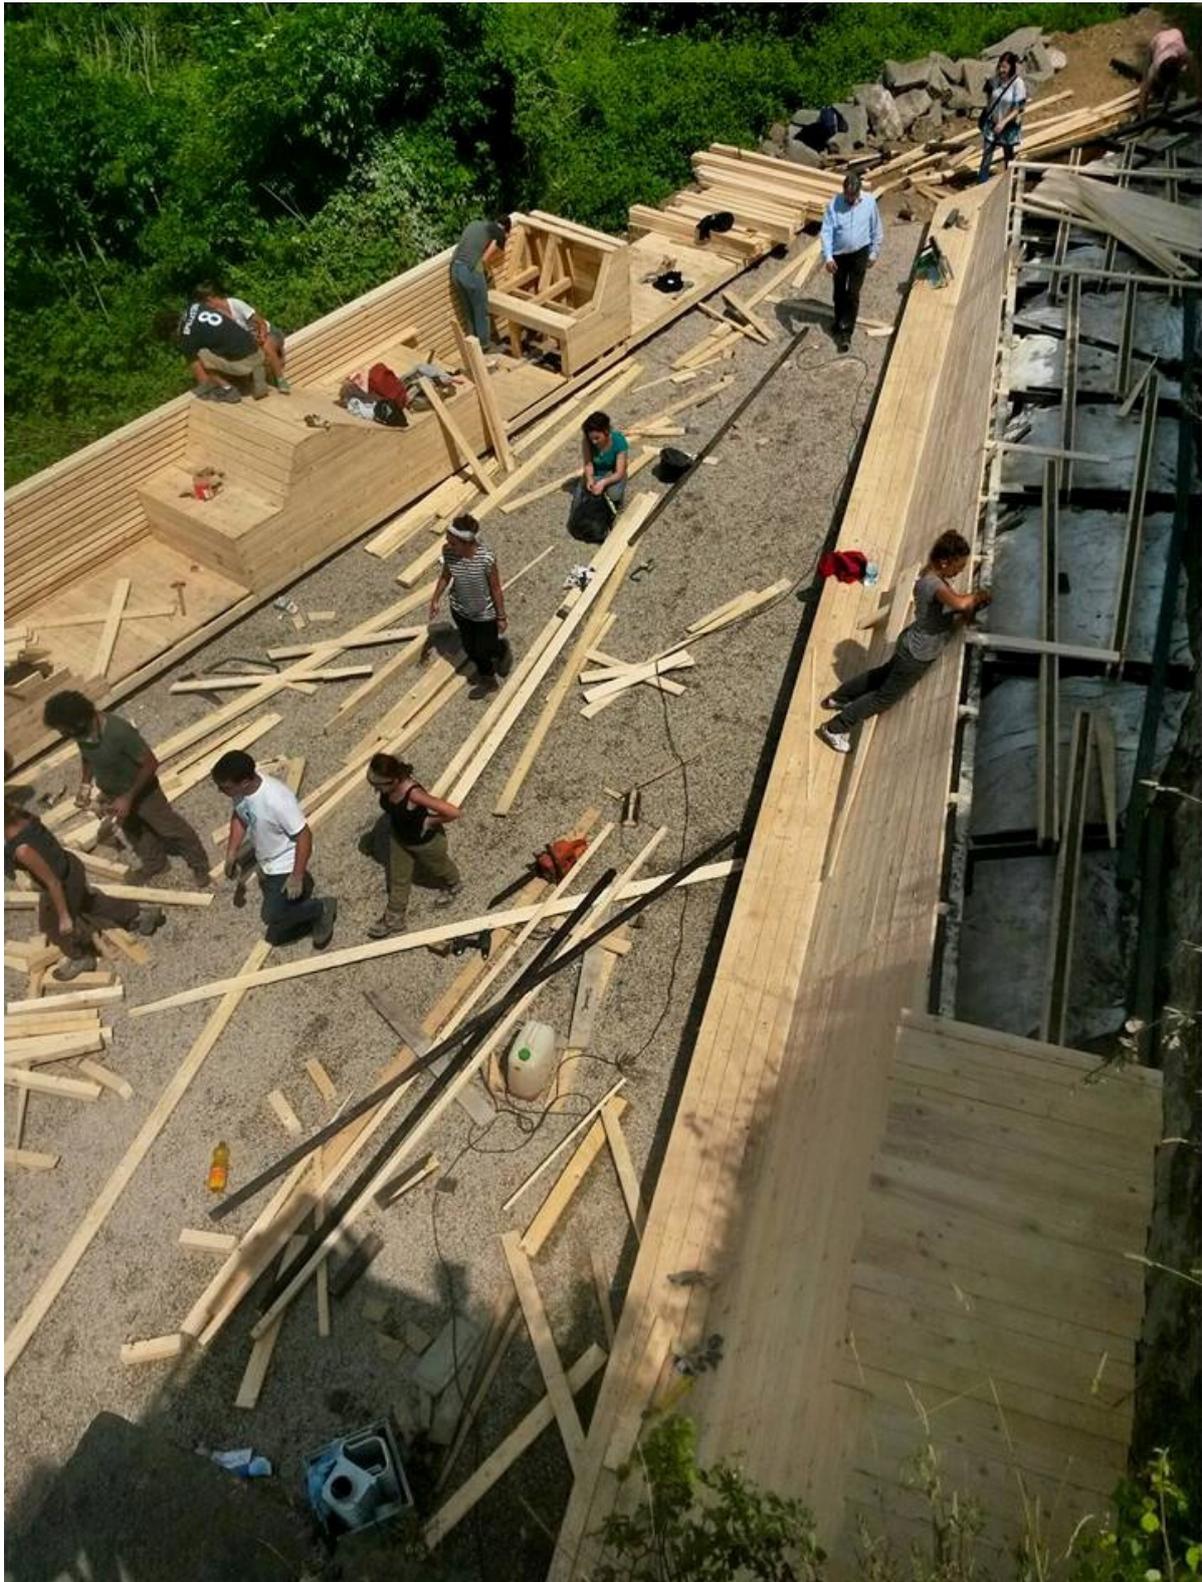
Il cantiere allestito durante il workshop di autoconstruzione
